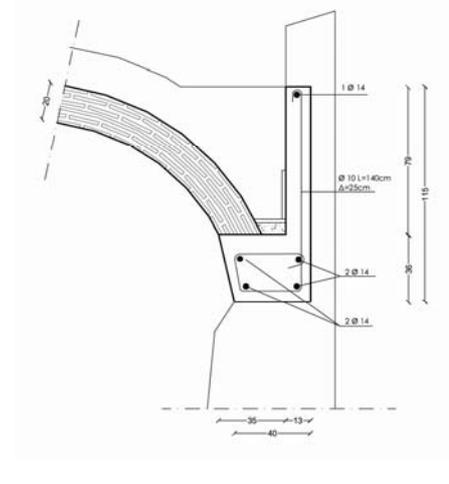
Particolare strutturale della trave perimetrale del pasillo
